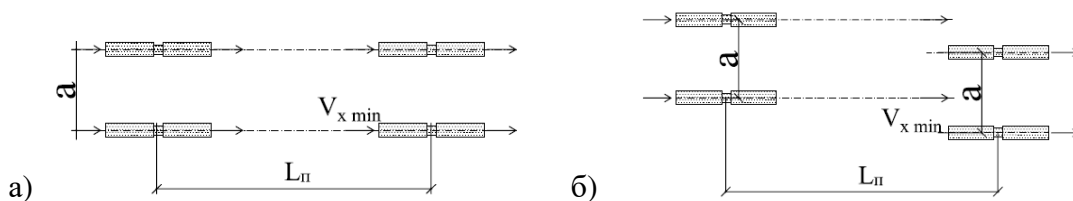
Схема взаимного расположения струйных вентиляторов. а – соосная установка струйных вентиляторов; б – параллельная установка струйных вентиляторов
